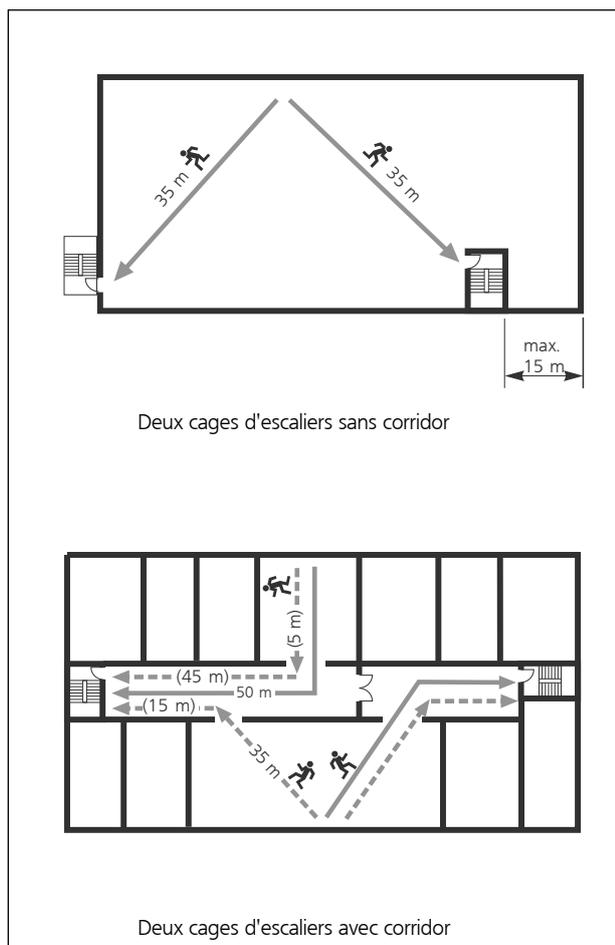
Exemple d'un étage avec deux ou plusieurs cages d'escaliers
